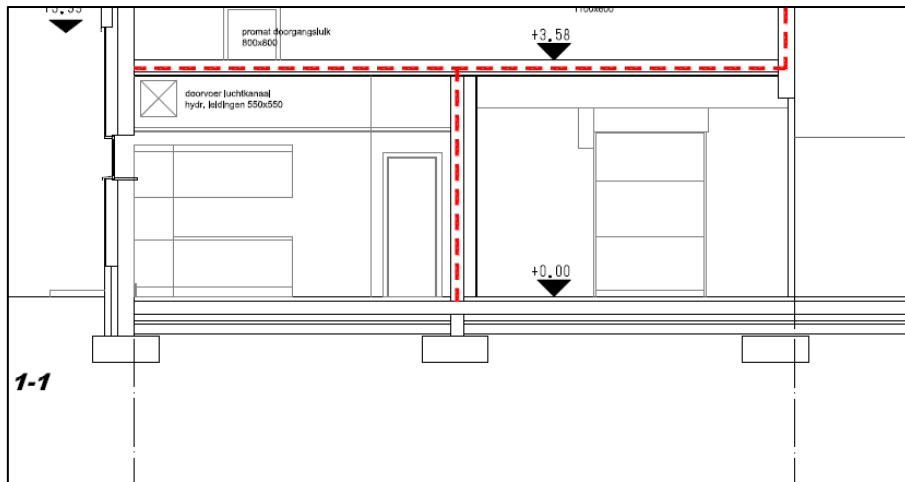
detail uit het doorsnedeplan met verduidelijking van de funderingsopbouw
